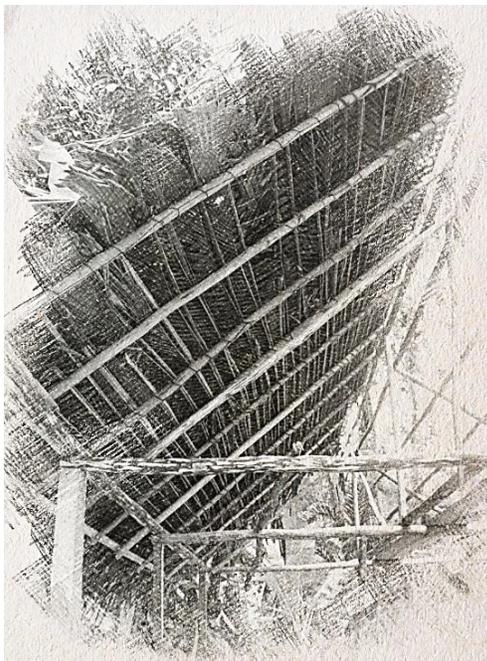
Construcción techo en madera rolliza y hoja de palma. El autor.
